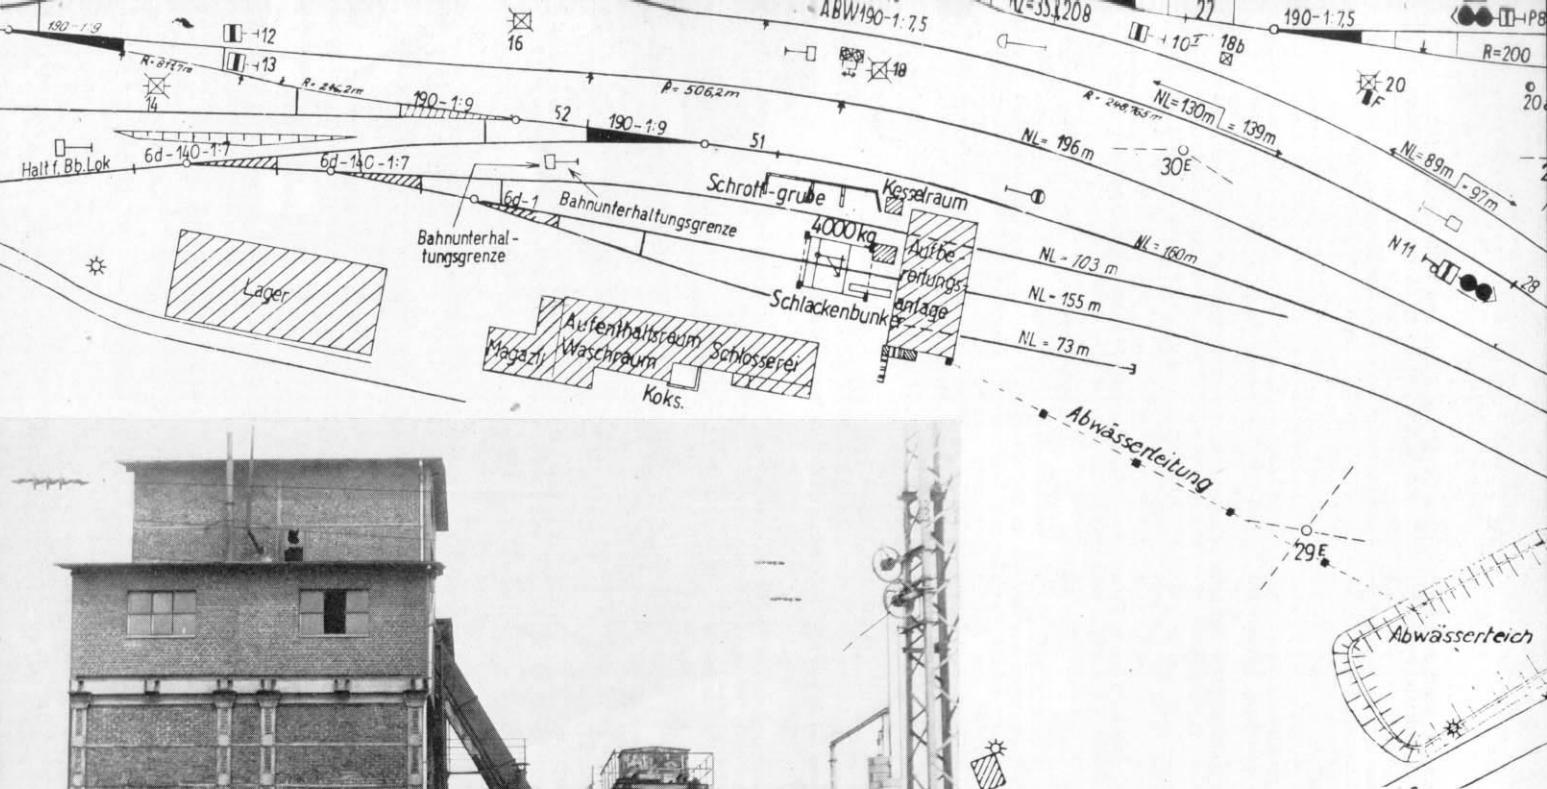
Lageplan des Schlackenwerks. Aus den Schildern „Bahnunterhaltungsgrenze“ und „Halt für Bundesbahn-Lok“ geht hervor, daß es sich bei den Anschlußgleisen um Privat-Anschlußgleise handelt.
